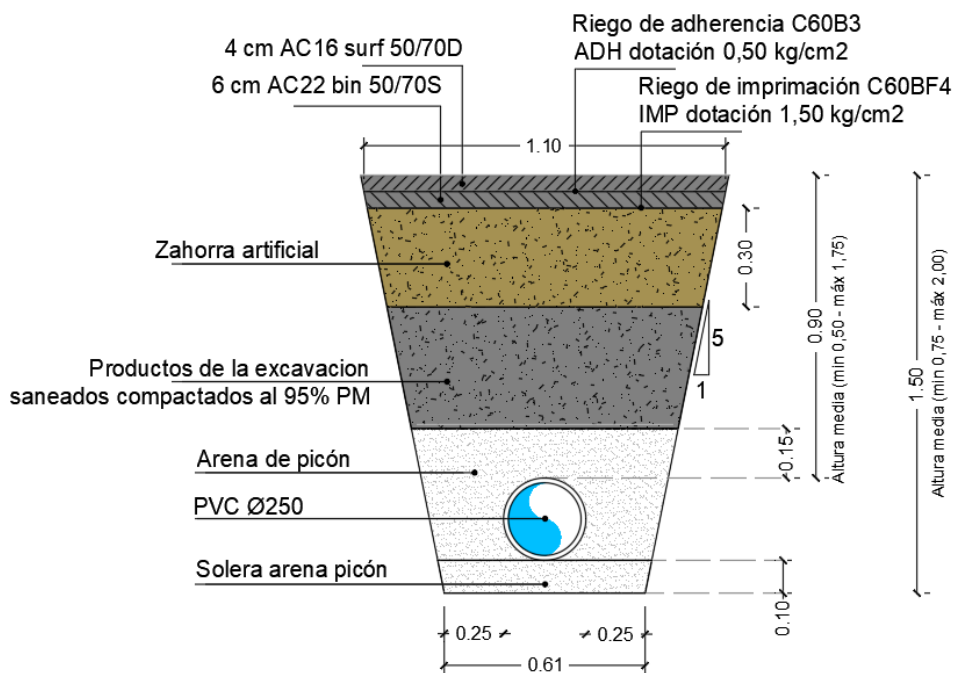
Figura VIII. Sección tipo en tramo de calzada. Desagüe.
